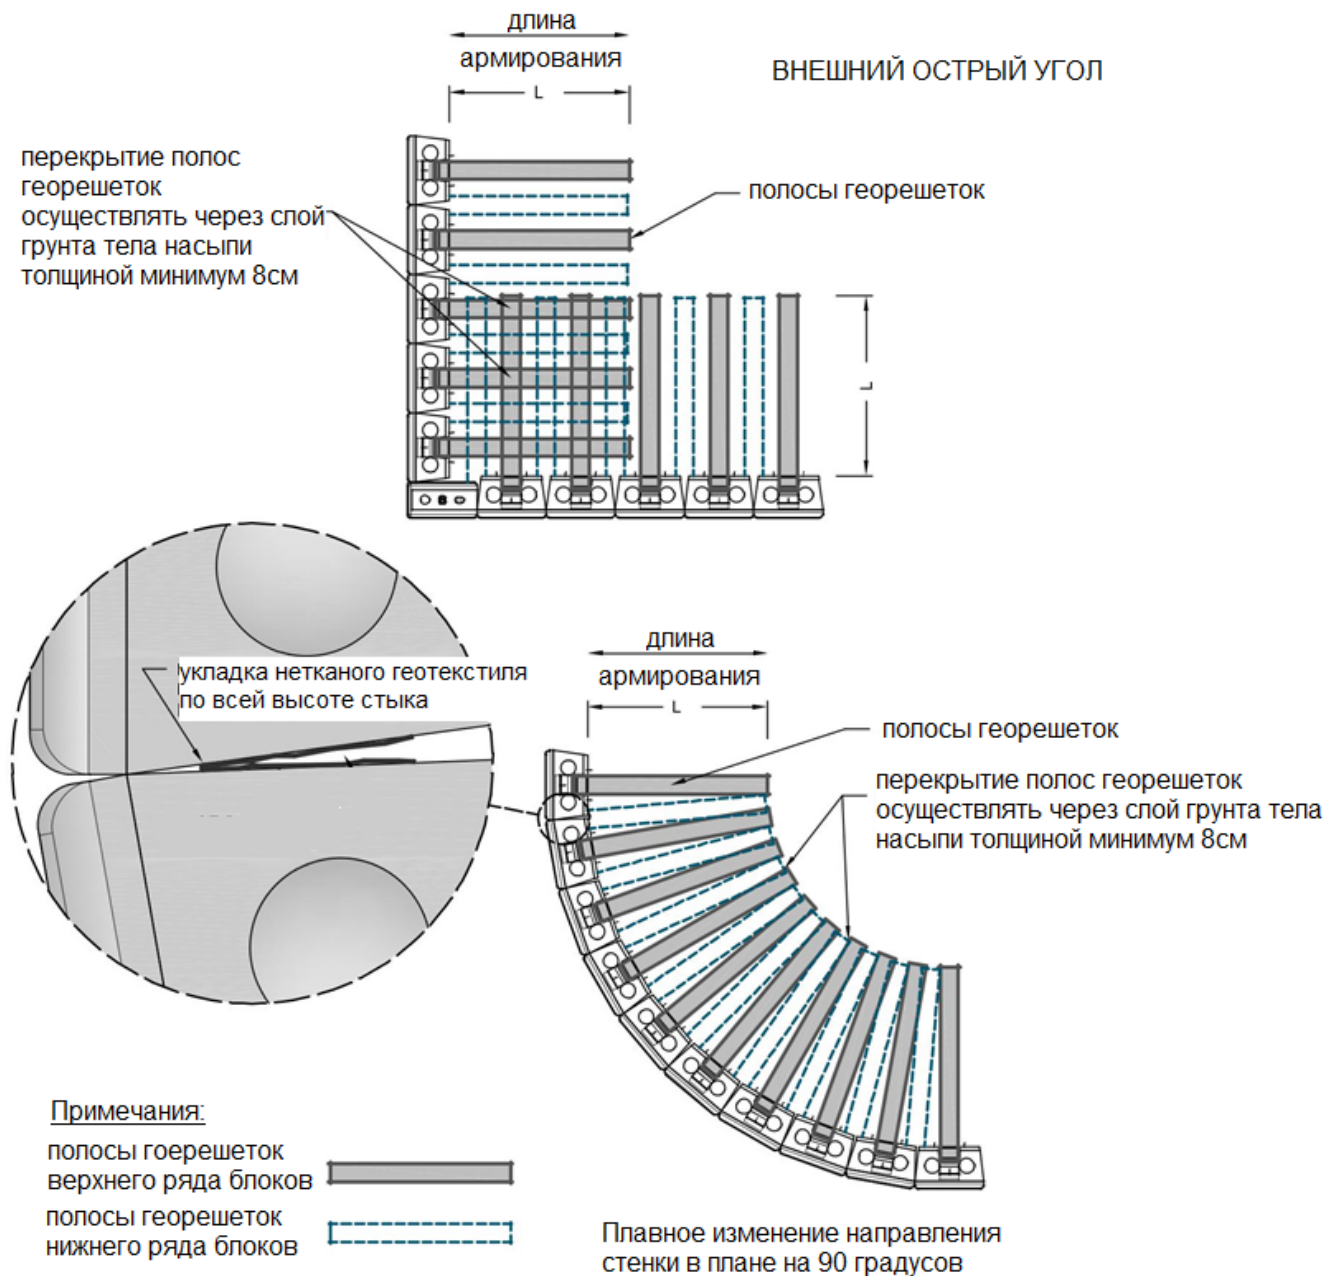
Расположение армирующих георешеток в стенках типа АГ 1 с внешними углами поворотов в плане
